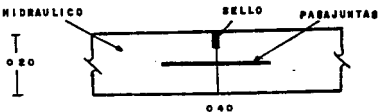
JUNTA TRANSVERSAL DE CORTE
